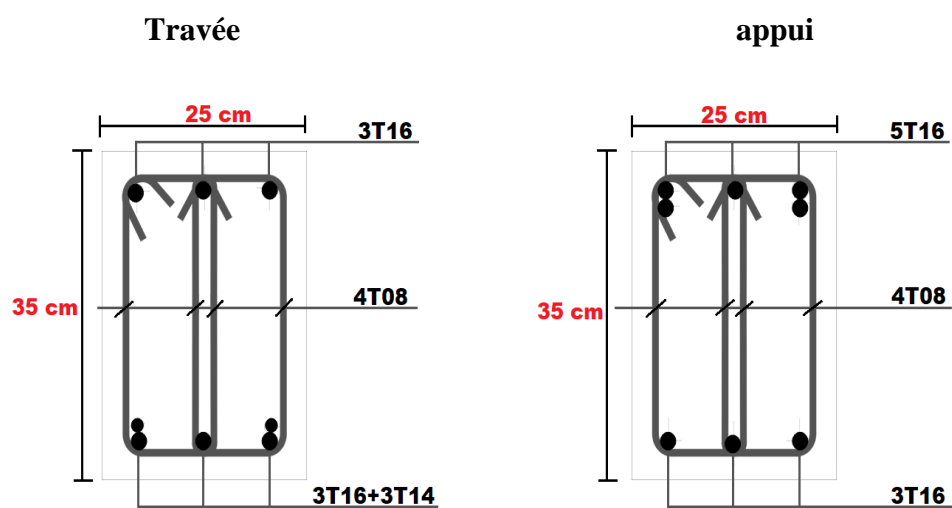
ferrailage des poutres secondaires 25×35 (RDC-8^{ème} étage).
